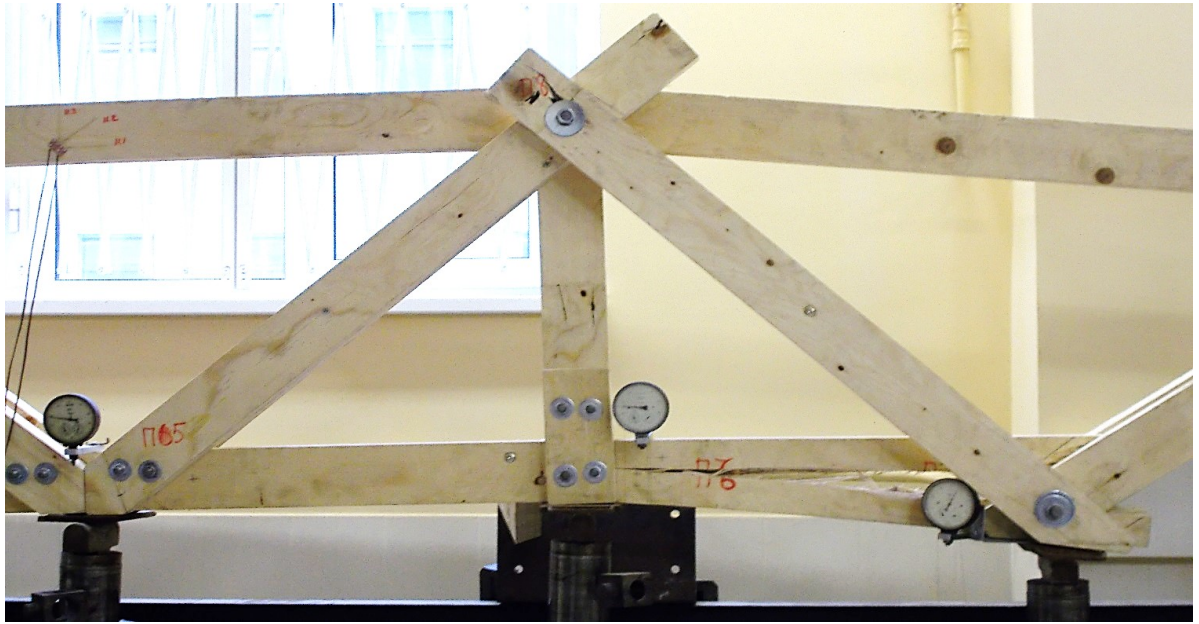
Разрушение конструкции фермы при испытаниях.
